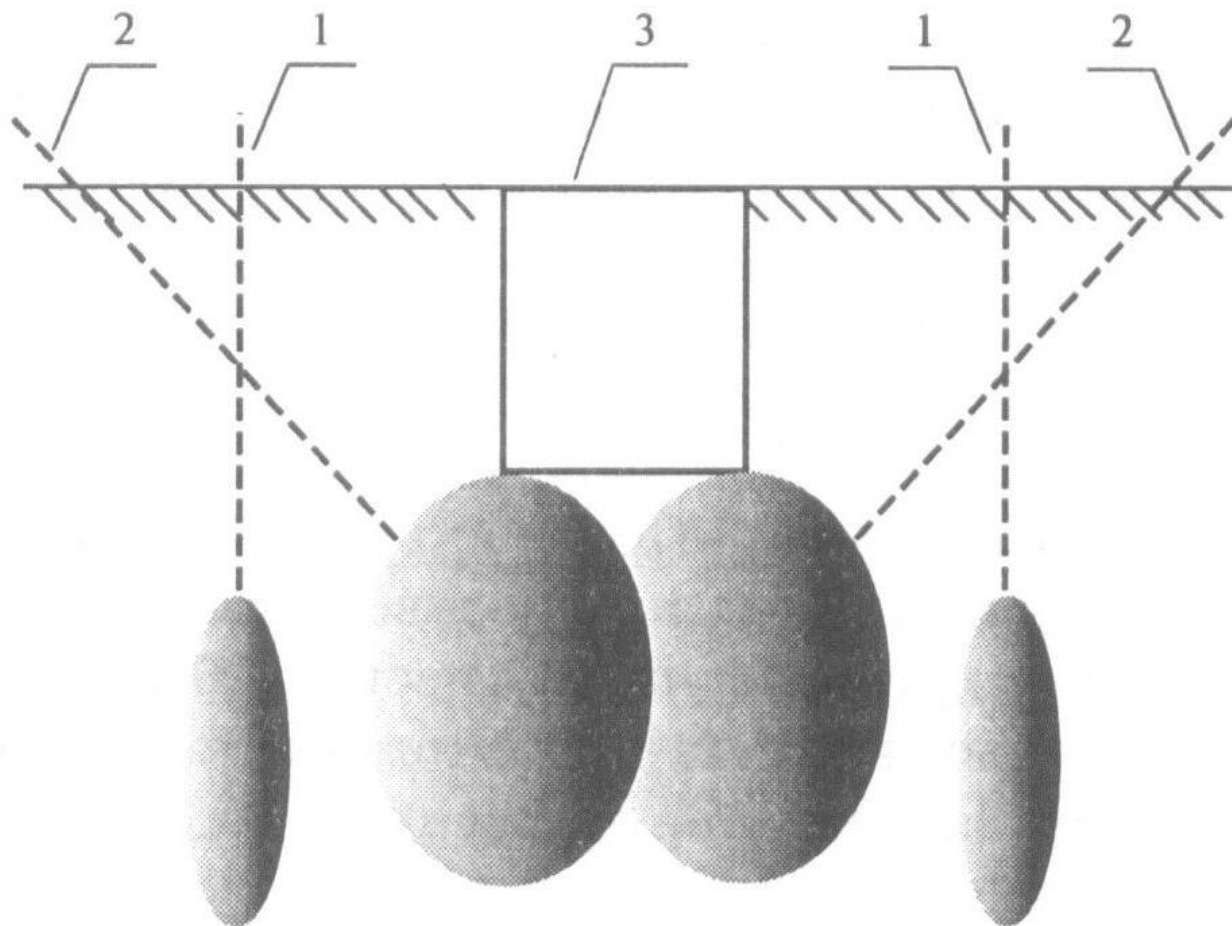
Поэтапное укрепление грунта основания фундамента:
